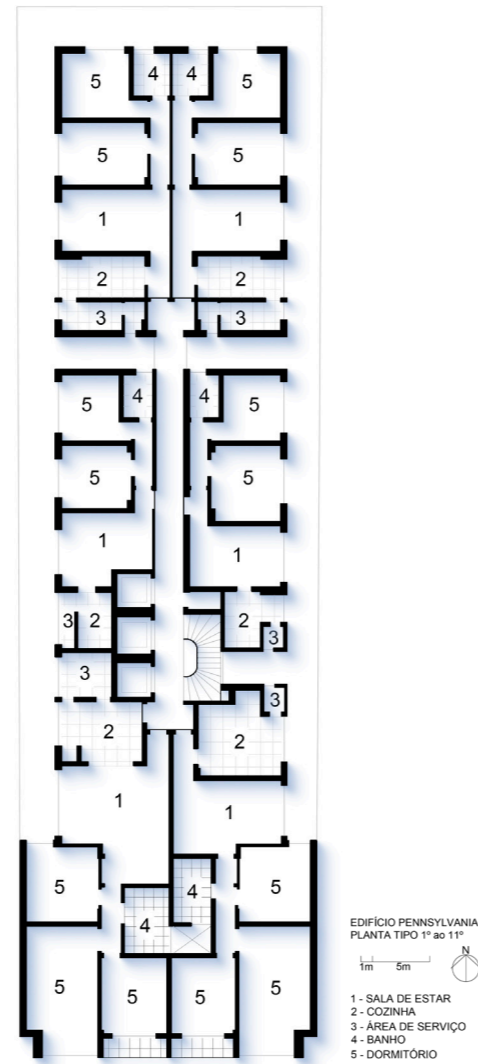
Redesenho Planta Tipo 1º ao 11º pavimento do Edifício Pennsylvania.
